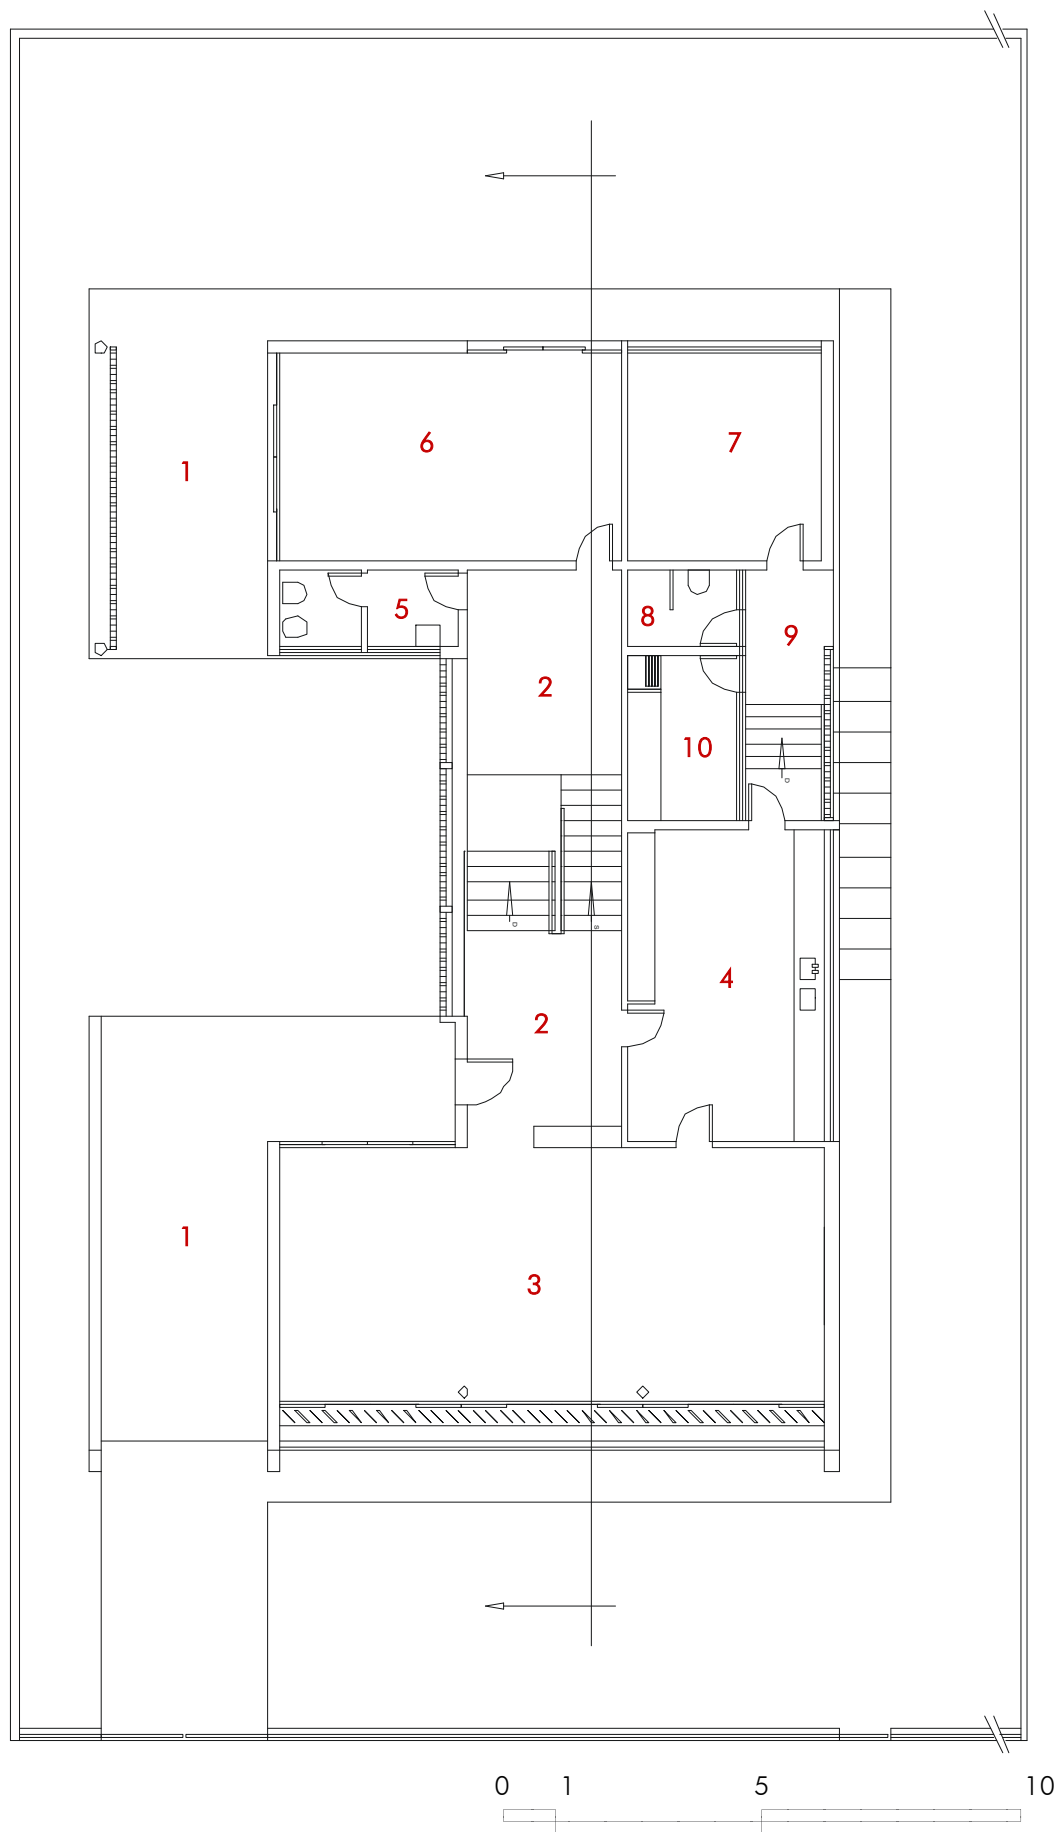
Planta pavimento térreo: Residência Luiz Bevilacqua.
